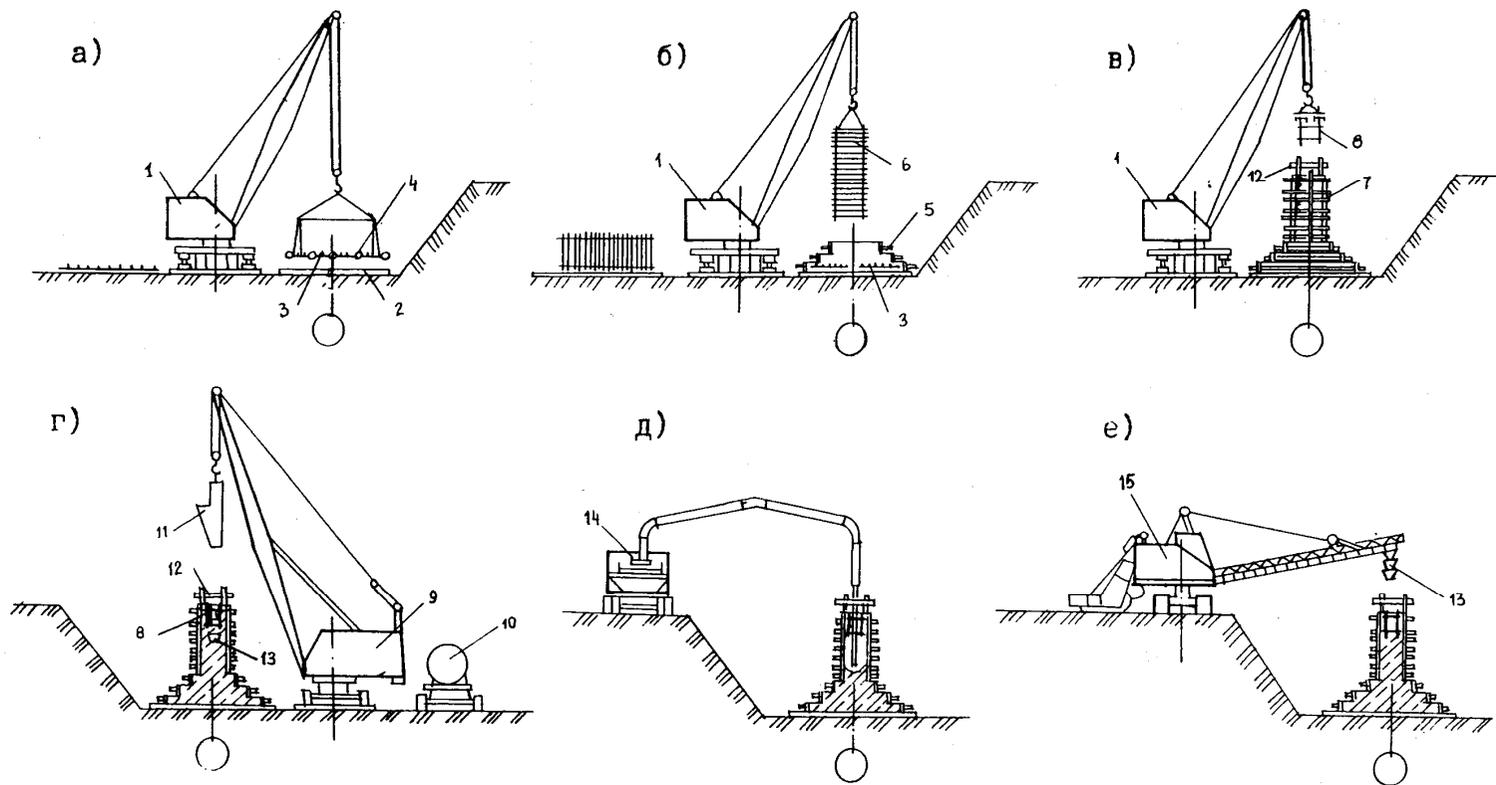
Технологические схемы возведения монолитных фундаментов под колонны:
